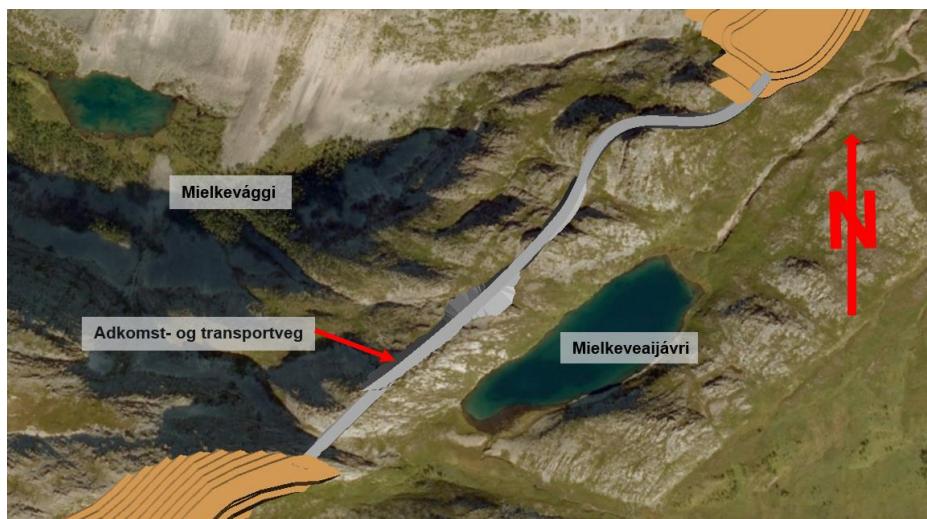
Oversikt planlagt nytt dagbrudd Vággečearru
